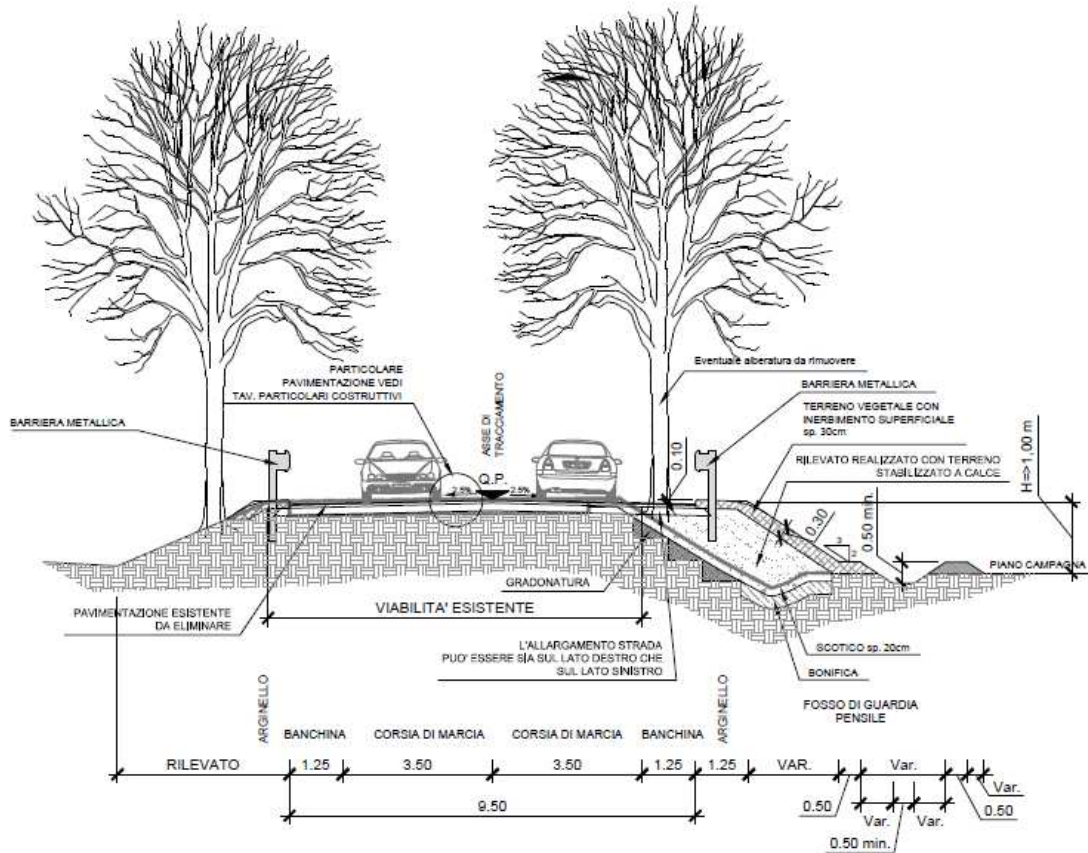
SEZIONE TIPO DI RISEZIONAMENTO
